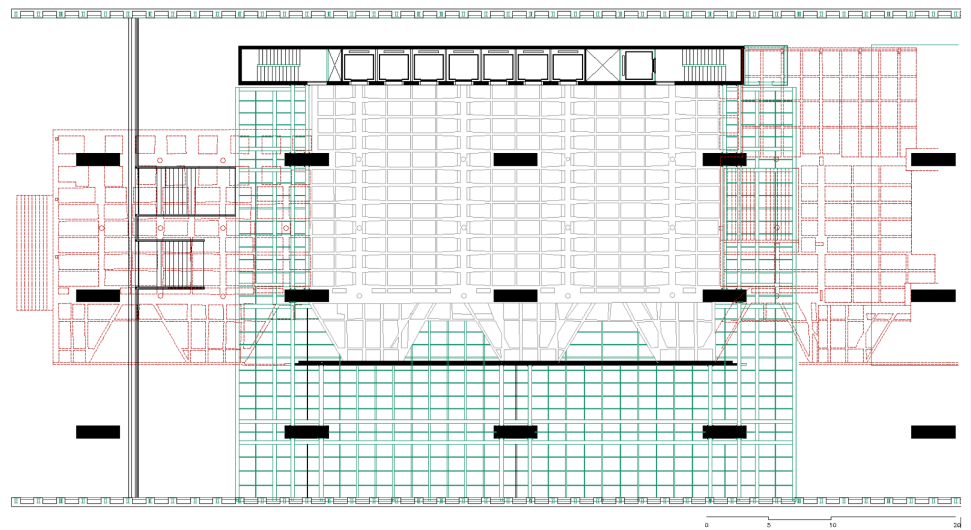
Planta de formas, demolición y estrutura metálica y porciones recortadas del techo de la planta baja y del piso de planta baja*. Fonte: Elaborado por los autores com base en archivos personal Paulo Mendes da Rocha (en cima); Kon (fotos).
